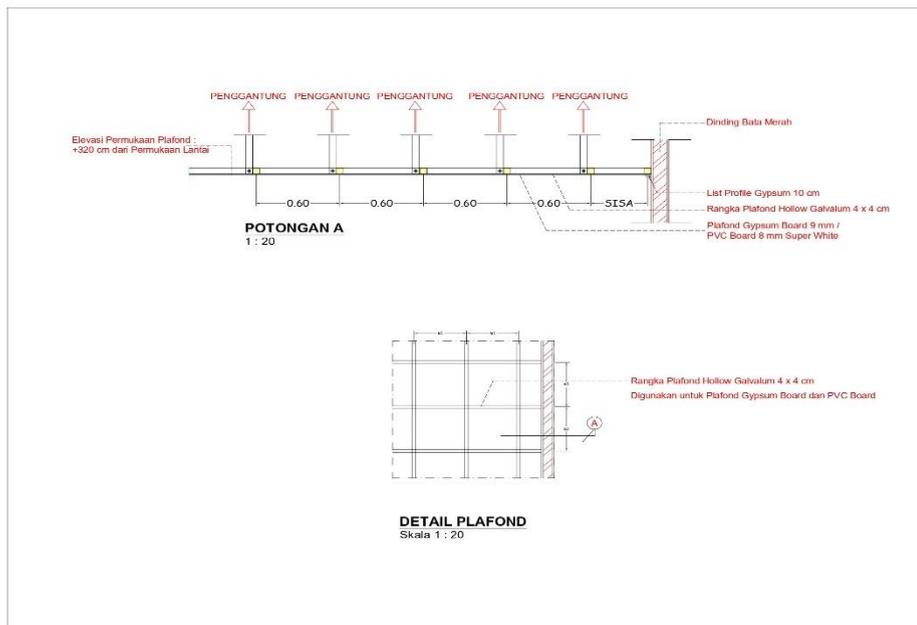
Denah Rencana Plafond Lt 1
